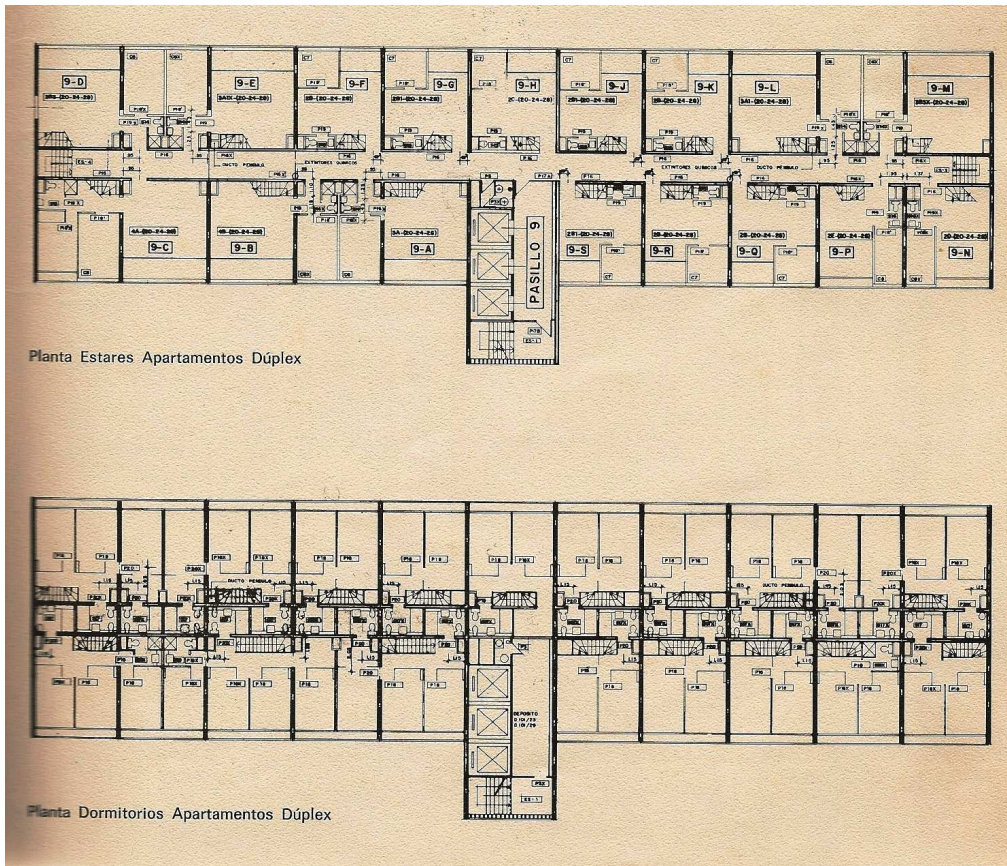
Plantas de Bloque de Viviendas y Apartamentos de Parque Central.
